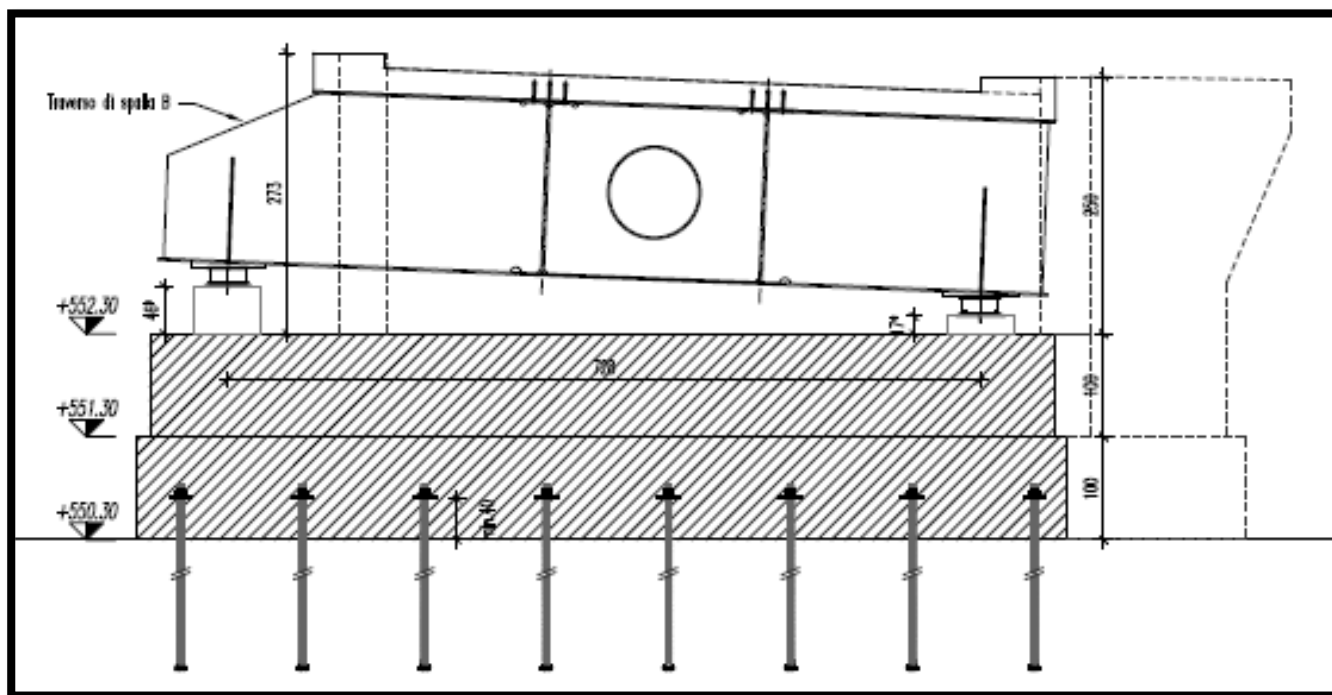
sezione della spalla B (spalla dx)
